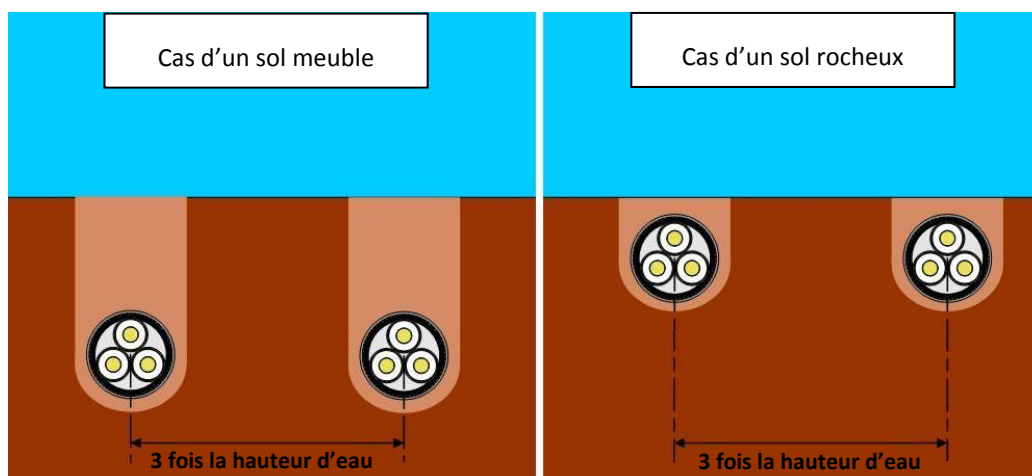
Schéma d'une installation de câble ensouillé (source RTE)
